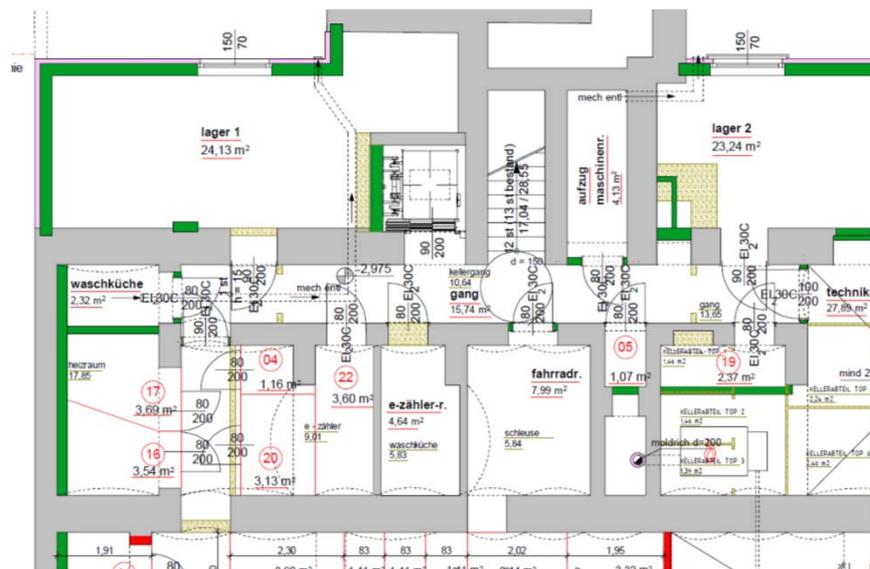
Wißgrillgasse 10, Kellergeschoß, Lage Fahrradraum. (Quelle: Ulreich)
